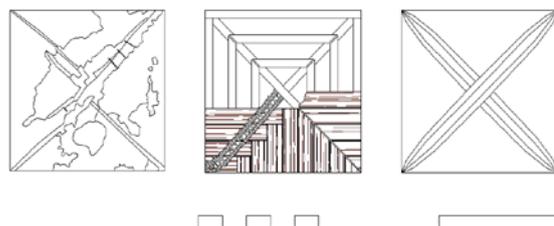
Levantamiento arquitectónico de la bóveda. Planta cenital e hipótesis de trazado y construcción.
